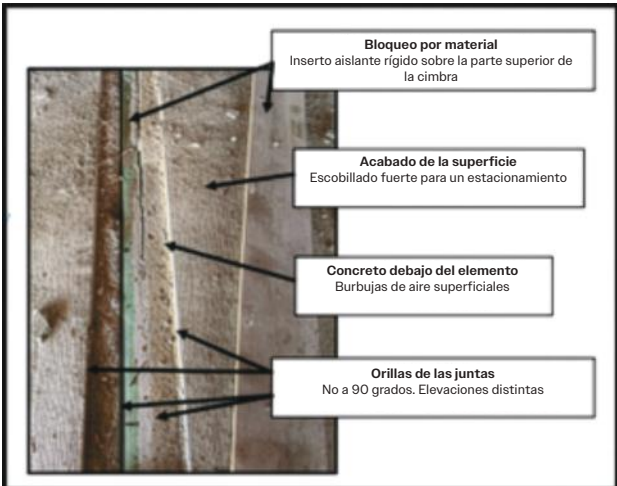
Caja de encofrado de junta de dilatación en estructura de estacionamiento.
